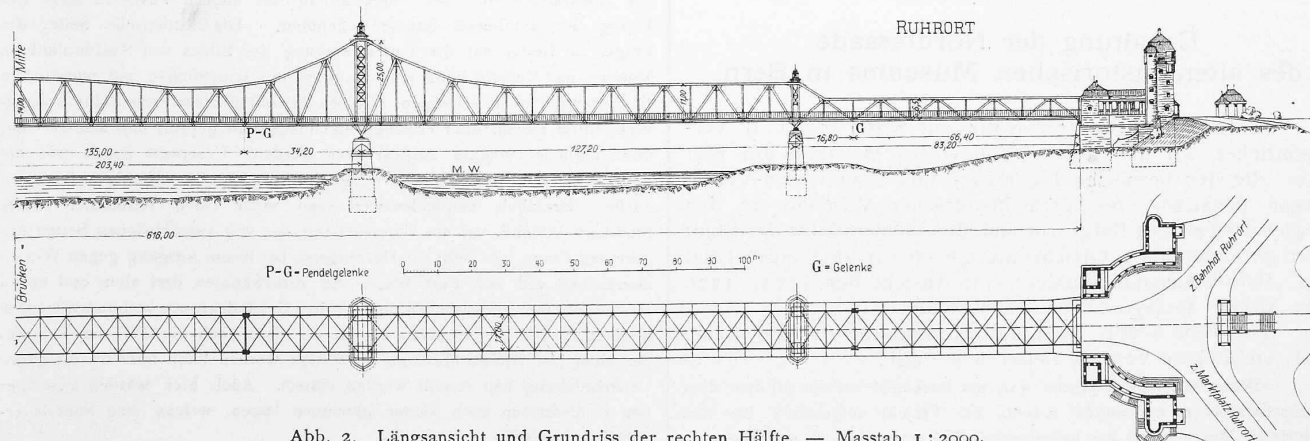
Längsansicht und Grundriss der rechten Hälfte. — Masstab 1 : 2000.
